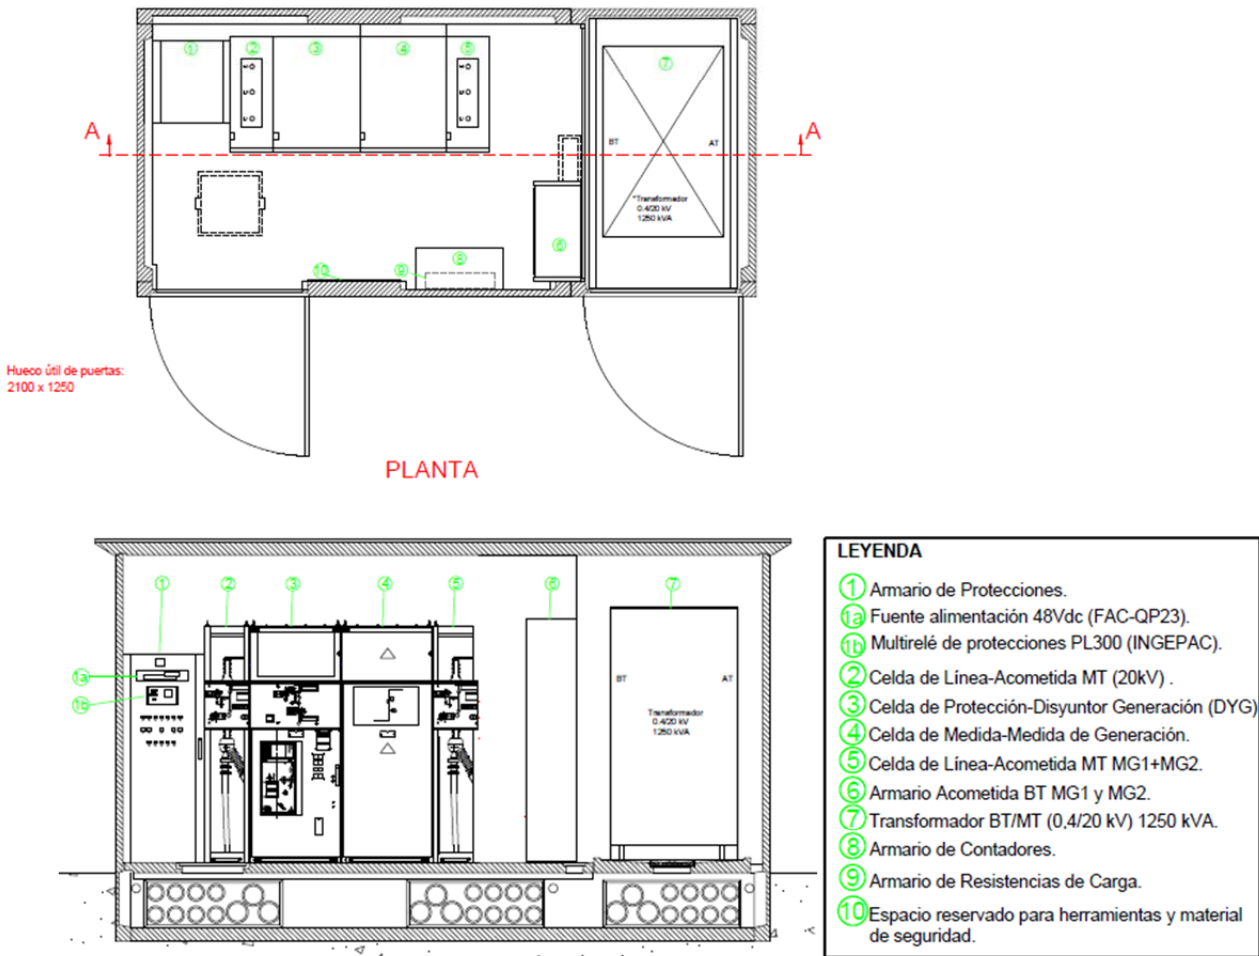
Vistas Planta y perfil de nueva caseta de entrega en planta de generación.
